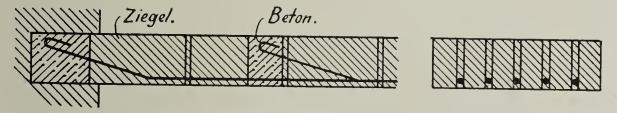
und 155. Eggertdecke aus Backsteinen.
